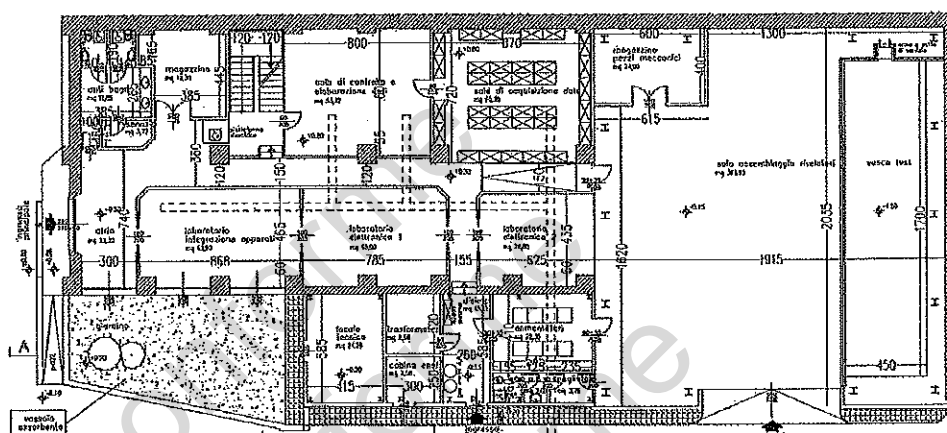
Pianta della stazione di terra di Portopalo di Capo Passero.
